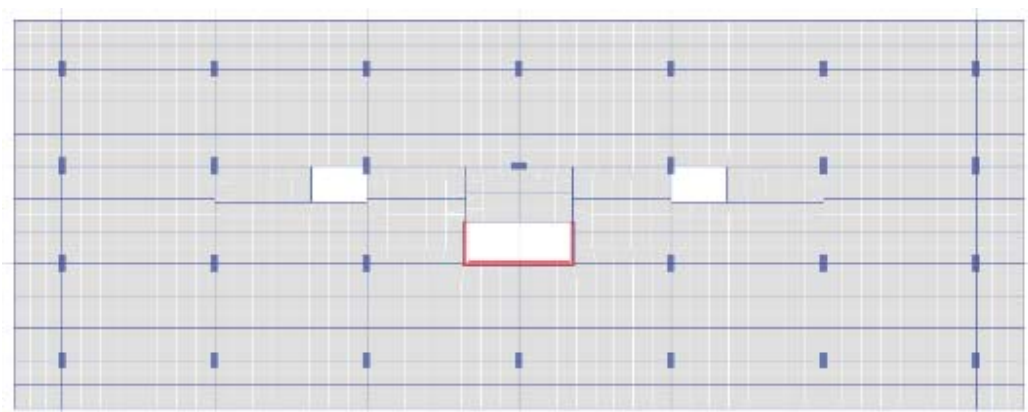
Planta modelo No. 1, luces de 11 metros en dirección x.
